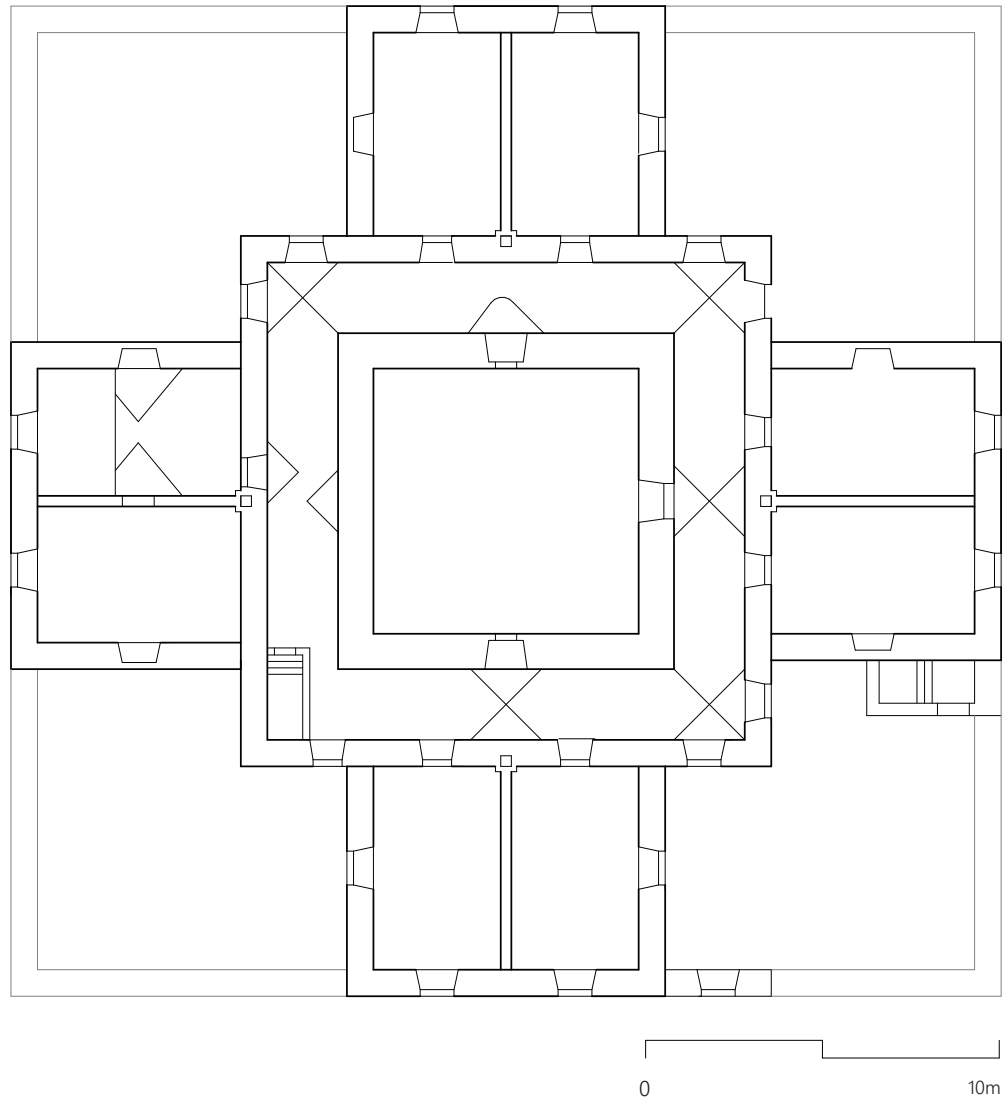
Grundriss Bürgerspital, Originalzustand
